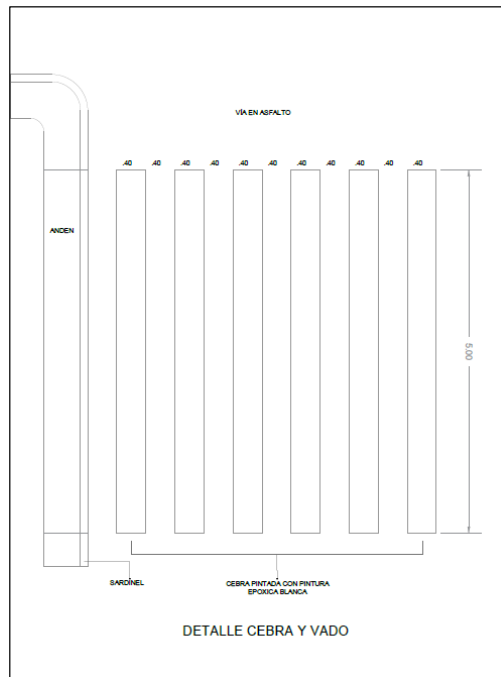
, Detalle técnico constructivo para la demarcación de las franjas peatonales.
